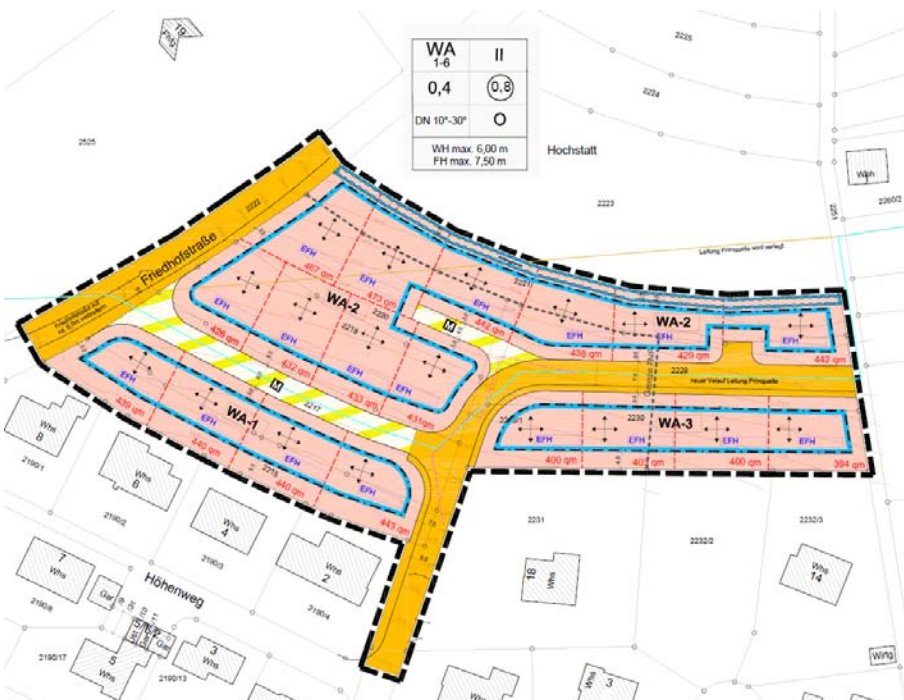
Lageplan mit dem Geltungsbereich (schwarz gestrichelt).
